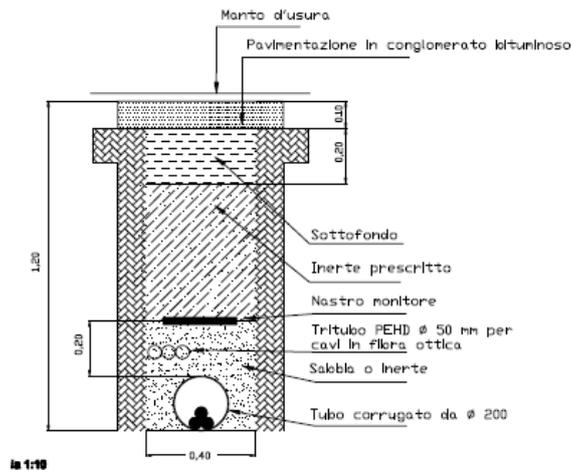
Sezione su strada asfaltata - posa di n°1 cavo MT
